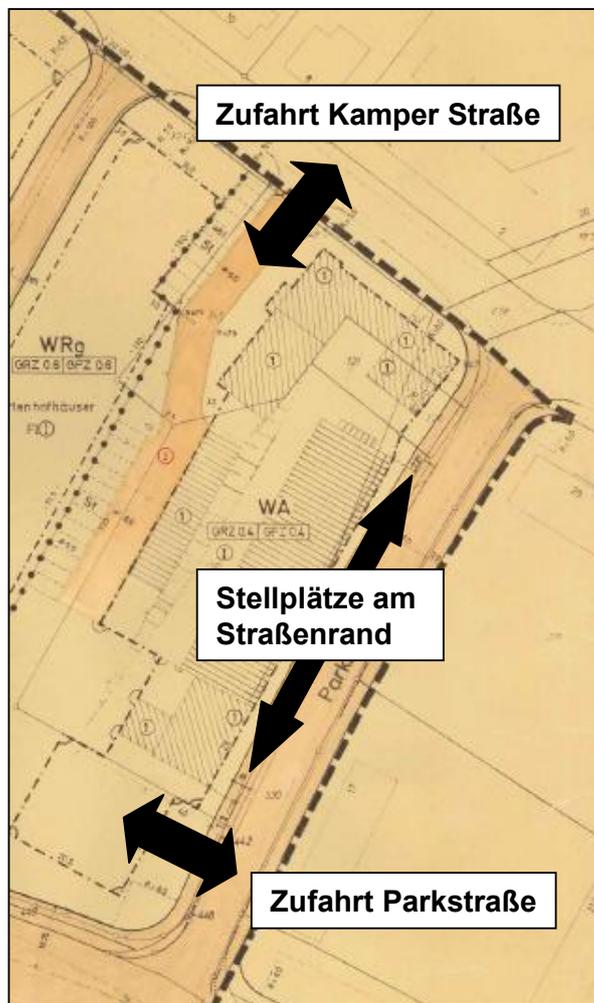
Zufahrtsituation (im Planfall entfällt die Zufahrt Kamper Straße)
